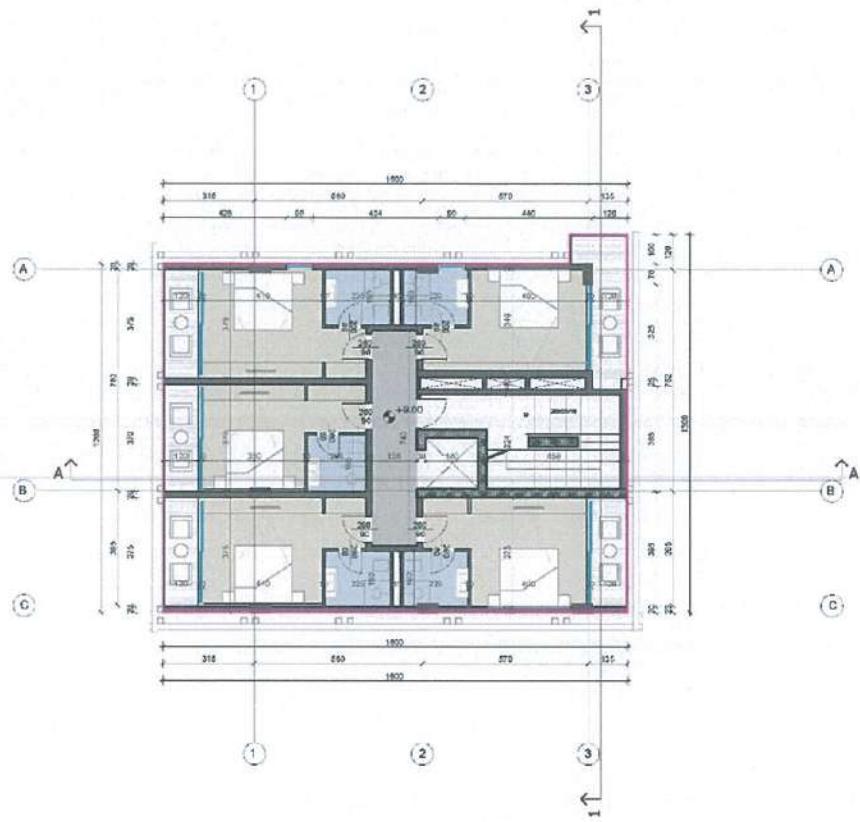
Planimetria e nivelit +2,+3,+4,+5
